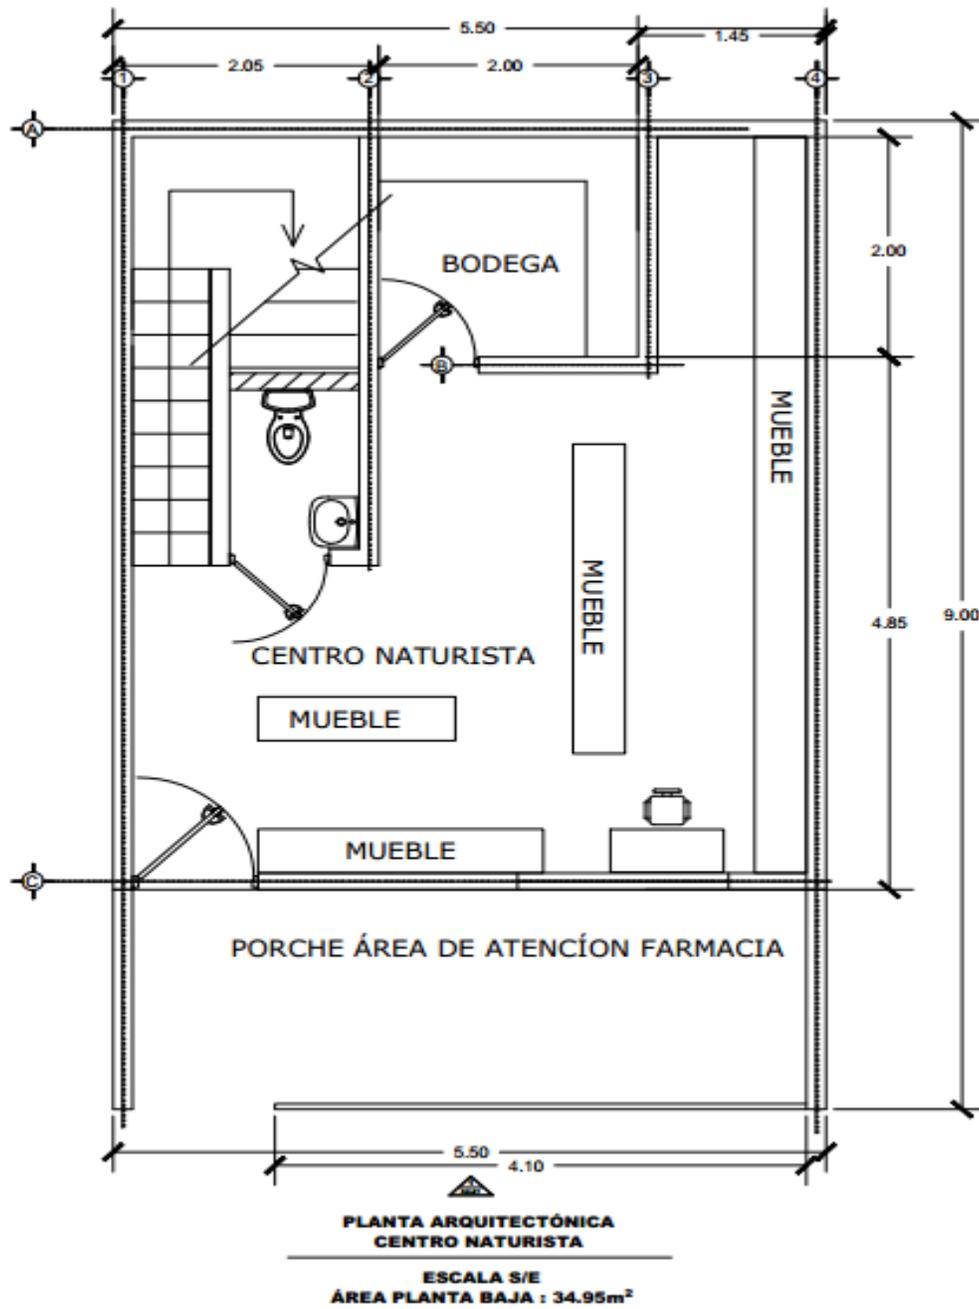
Estructura de planta baja Centro Naturista Vida Verde. Fuente: Autoría propia.
